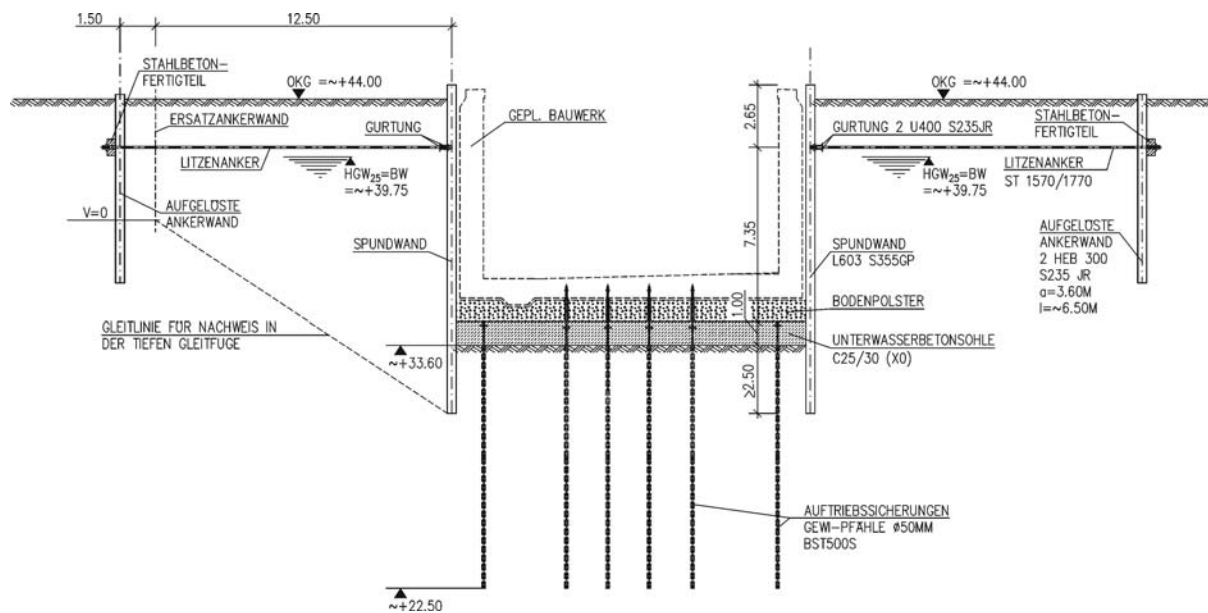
Baugrubenkonstruktion Typ 1 in Wand-Sohle-Bauweise (Trogbaugrube mit Unterwasserbetonsohle)
